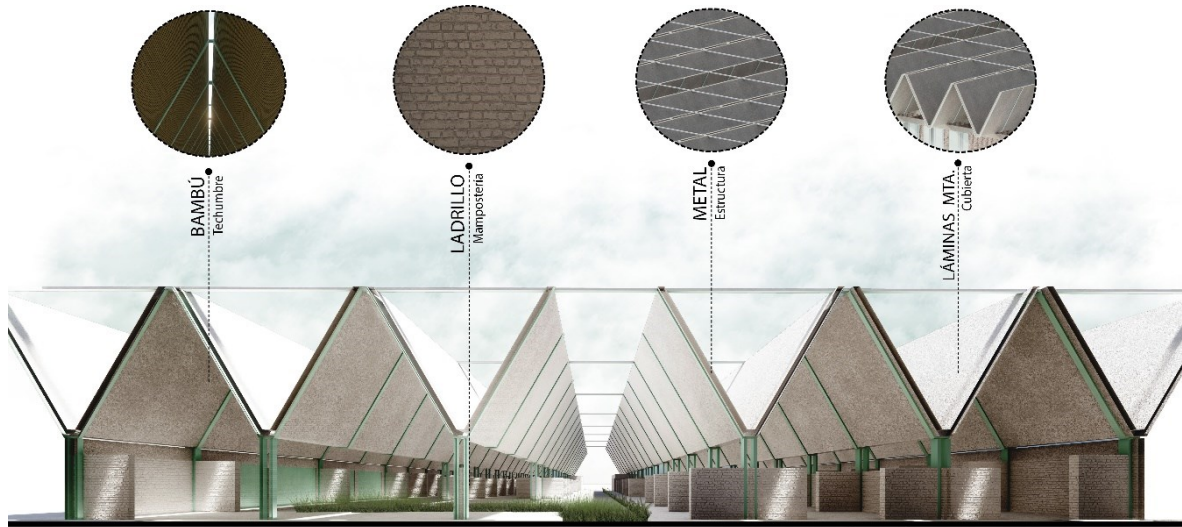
Elementos constructivos de la cubierta del mercado Guadalupe
